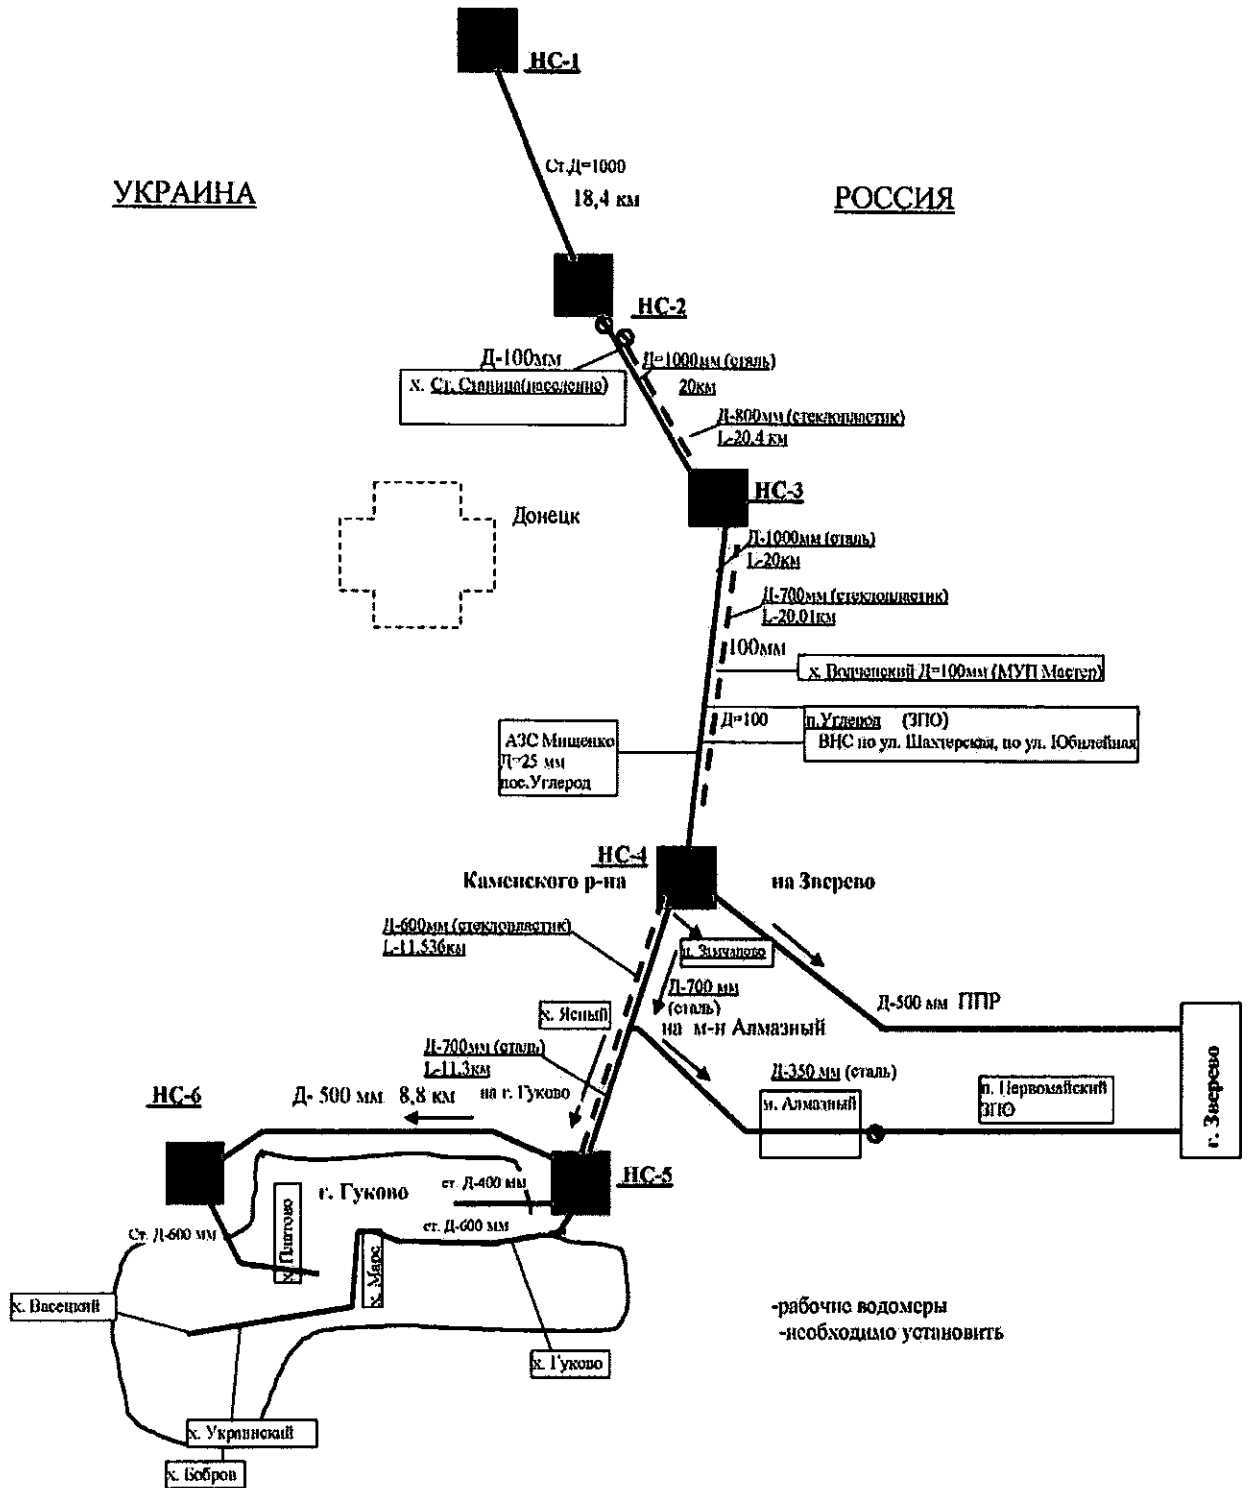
Принципиальная схема группового Гундорово-Гуковского водопровода.
